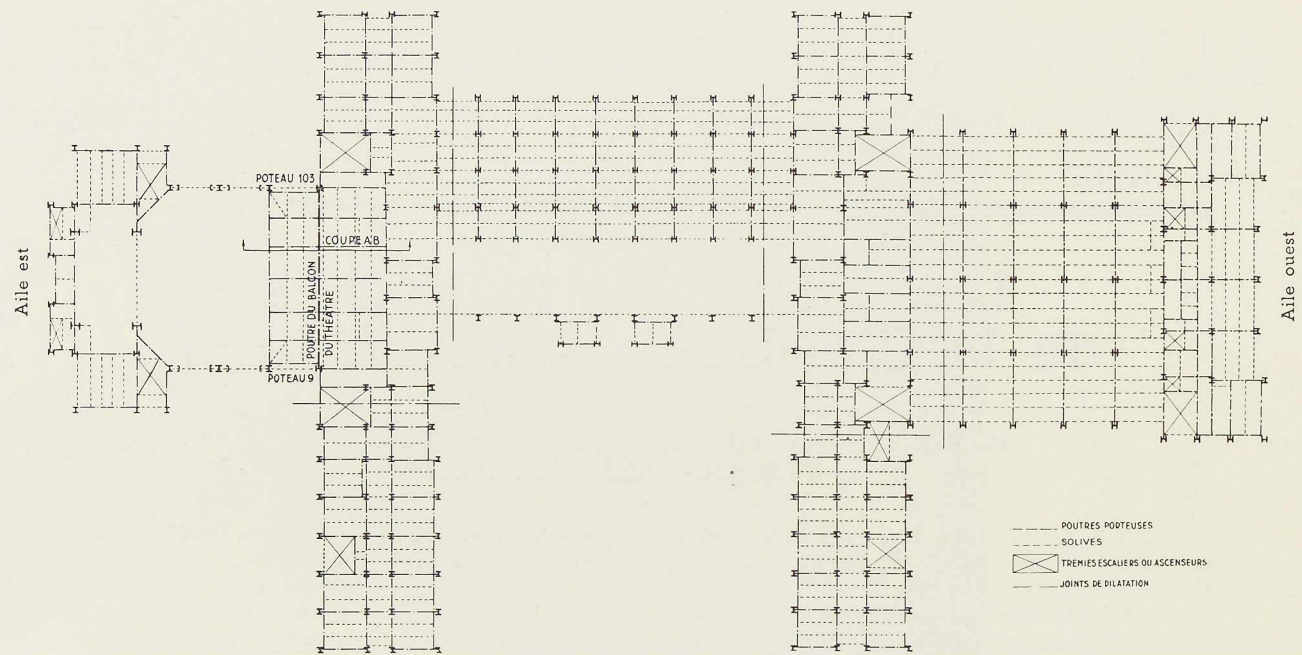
Plan d'ensemble de la charpente métallique au niveau du plancher haut du bel-étage. On trouvera des détails sur les poteaux 9 et 103 à la figure 75 et sur la poutre de balcon aux figures 84 à 86.
